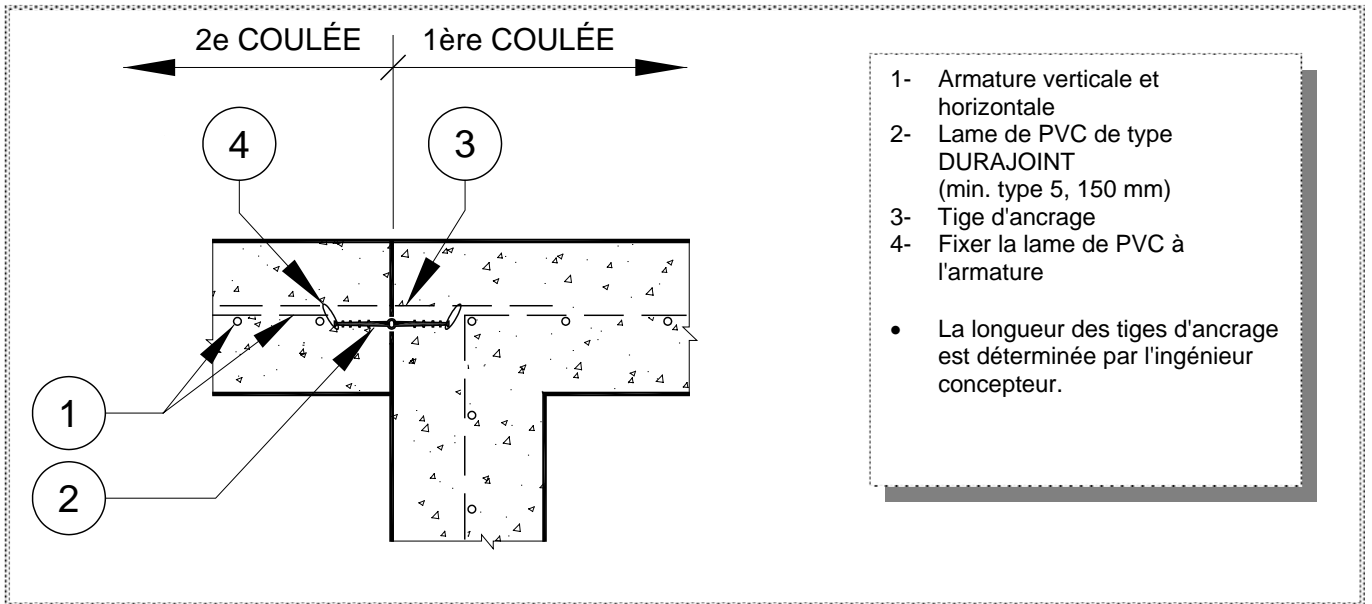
Étanchéité entre les murs d'une plate-forme et un putoir (Joint de construction)
